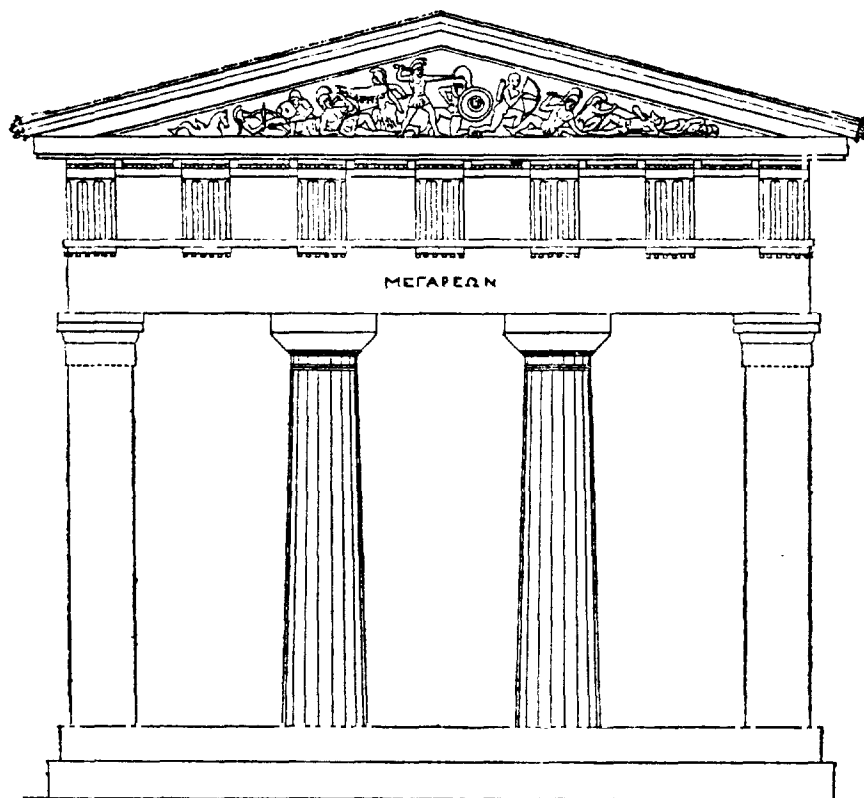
Fachada del Tesoro de Megara. Hacia el 510 a. d. J. C.
